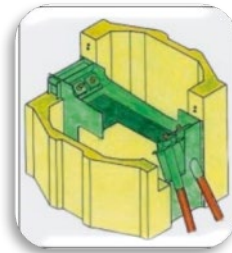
Esquema básico de las ensilladuras marca Freyssinet. Fuente: [33]
